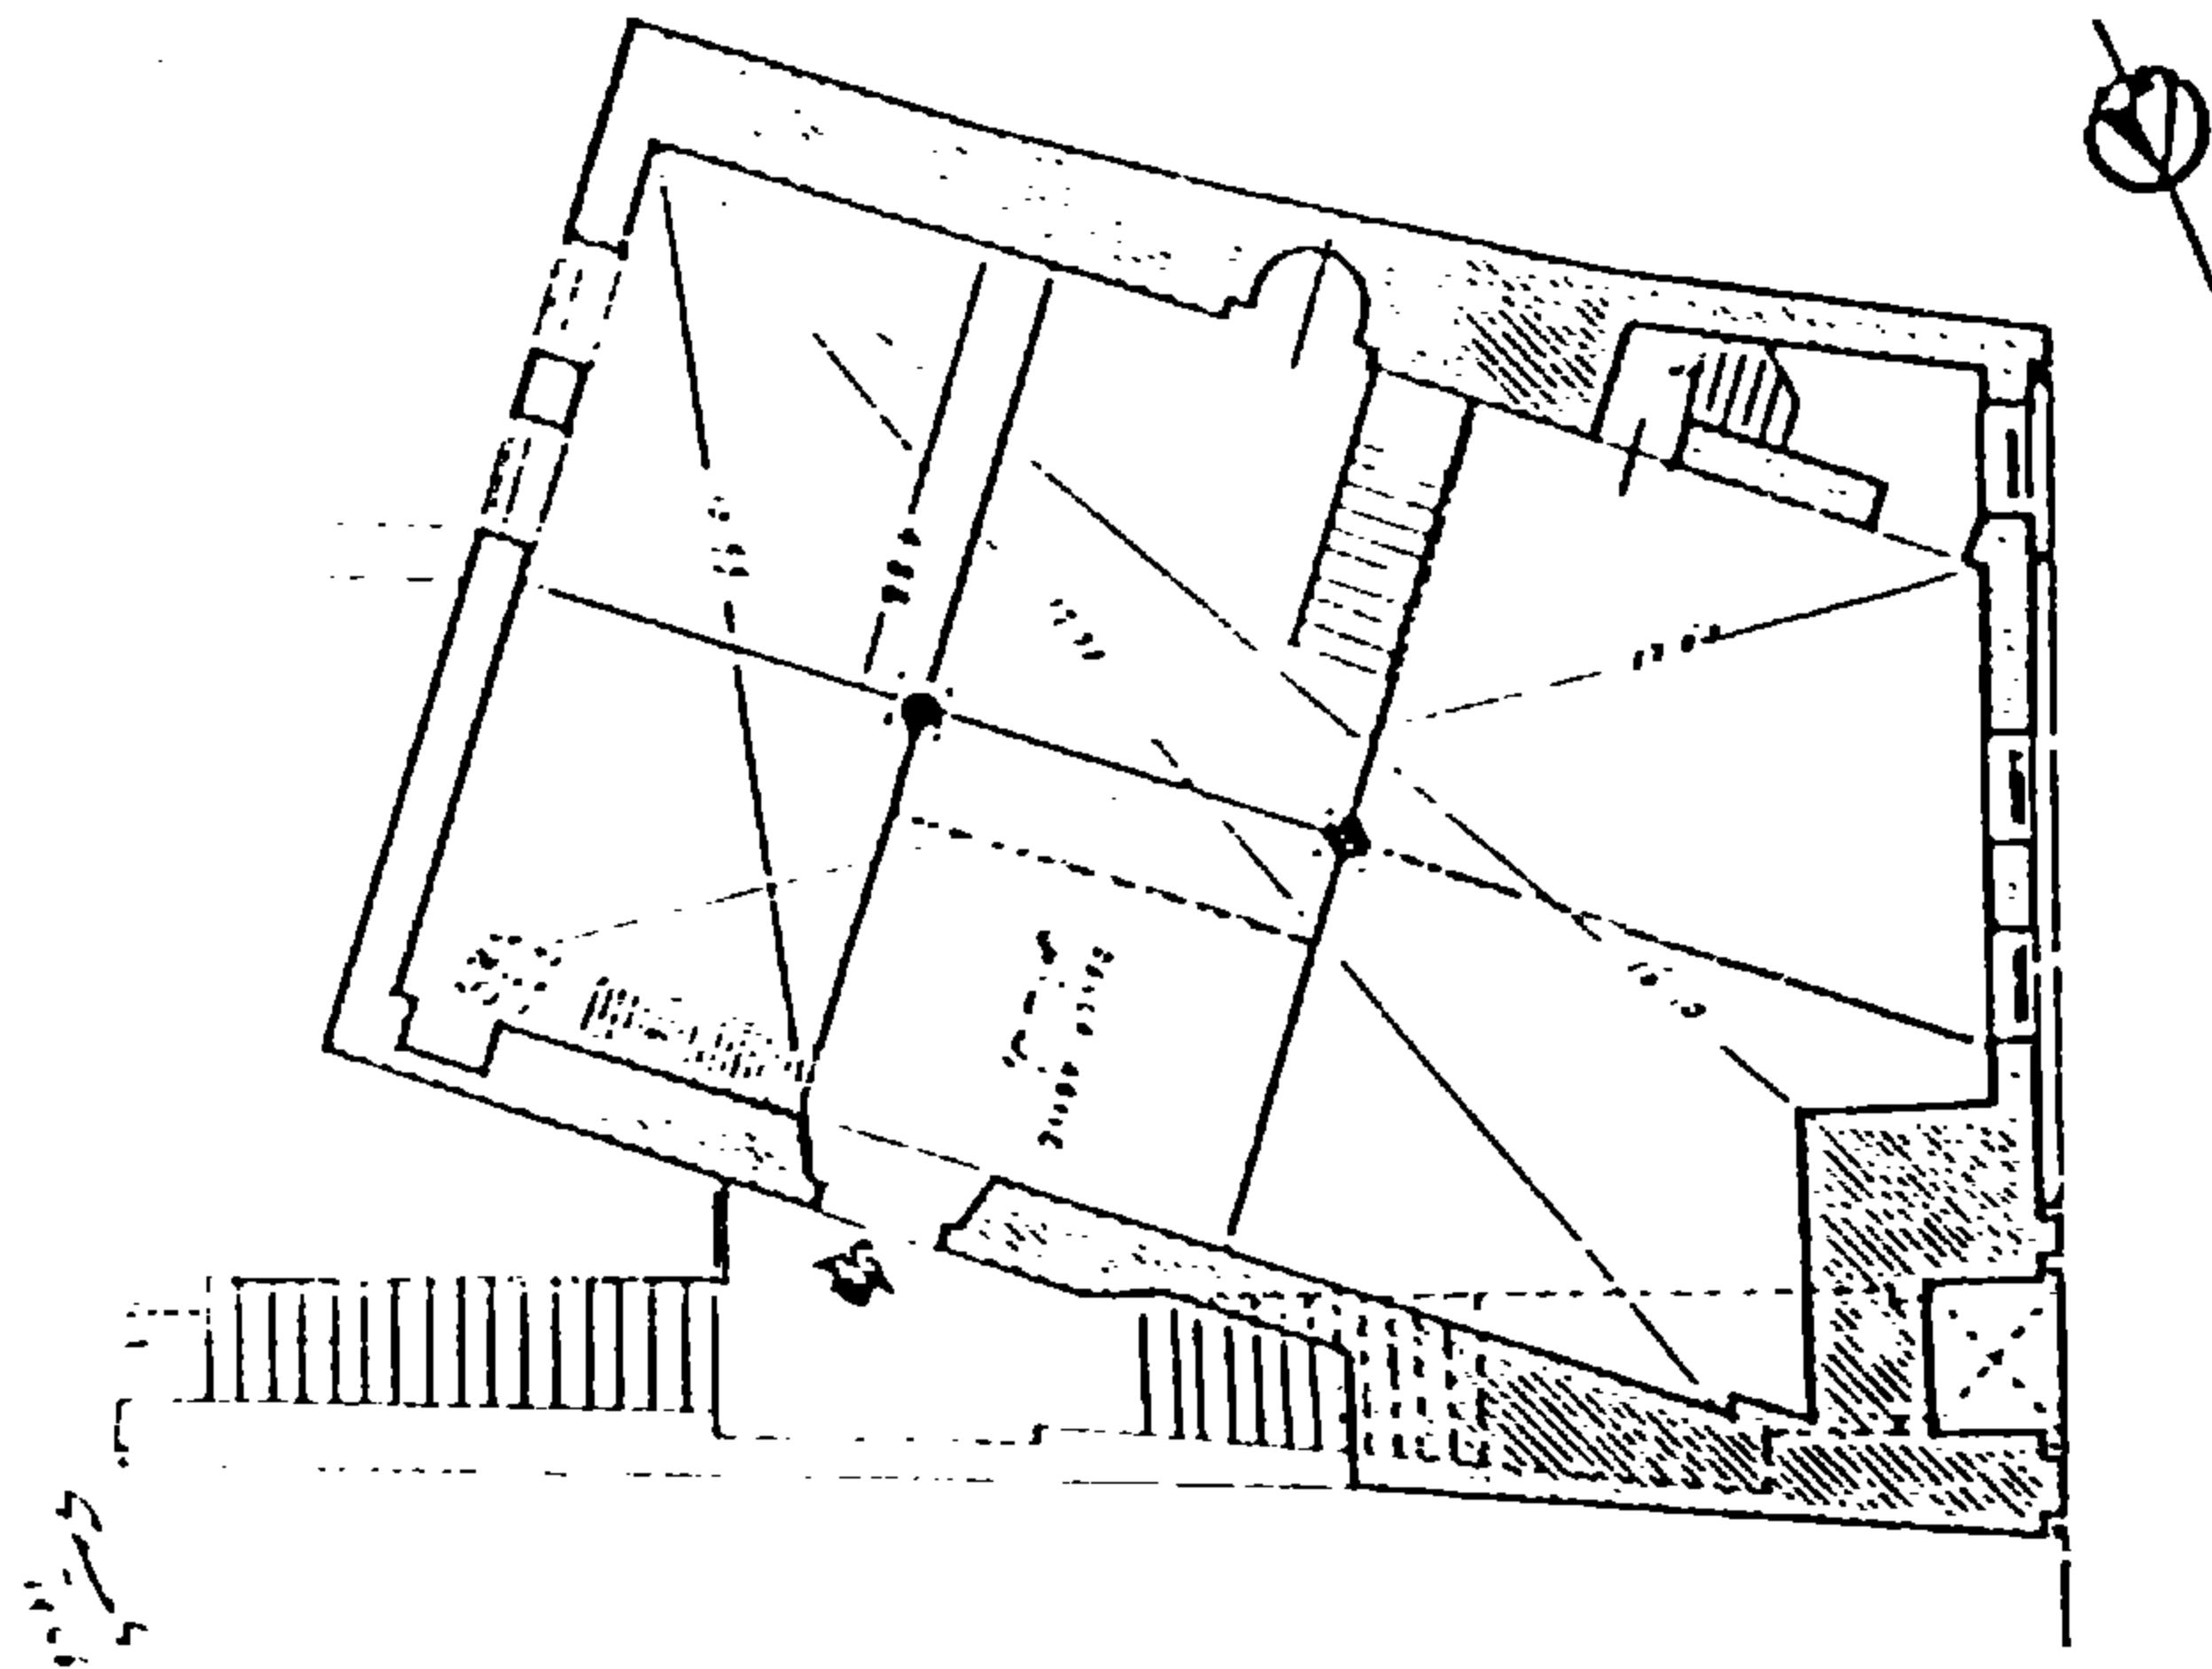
المقطع الأفقي لجامع مراد باشا
